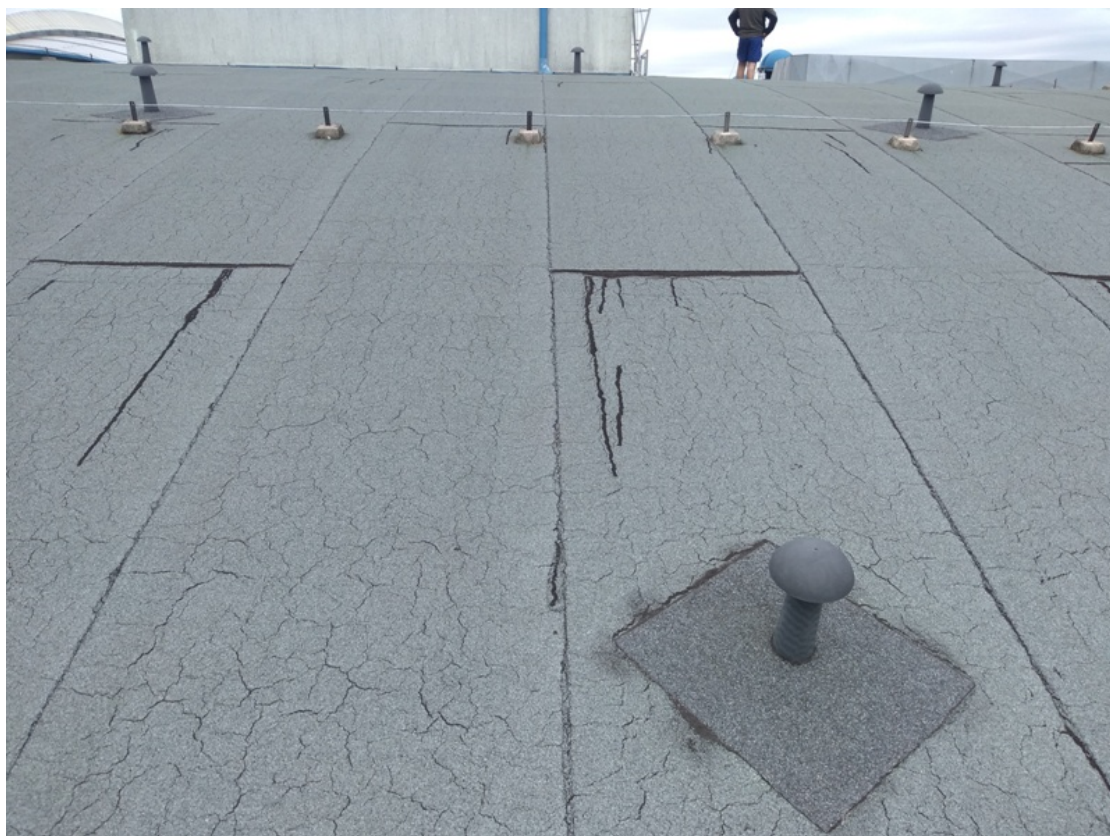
Izolacja przeciw-wodna przy świetliku dachowym
